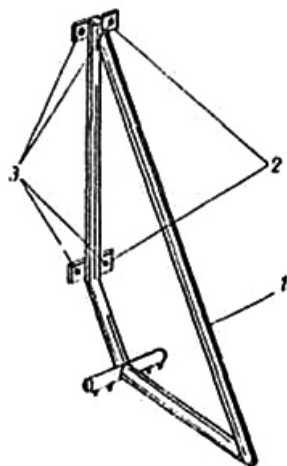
Упор для временного крепления гипсобетонных перегородок
